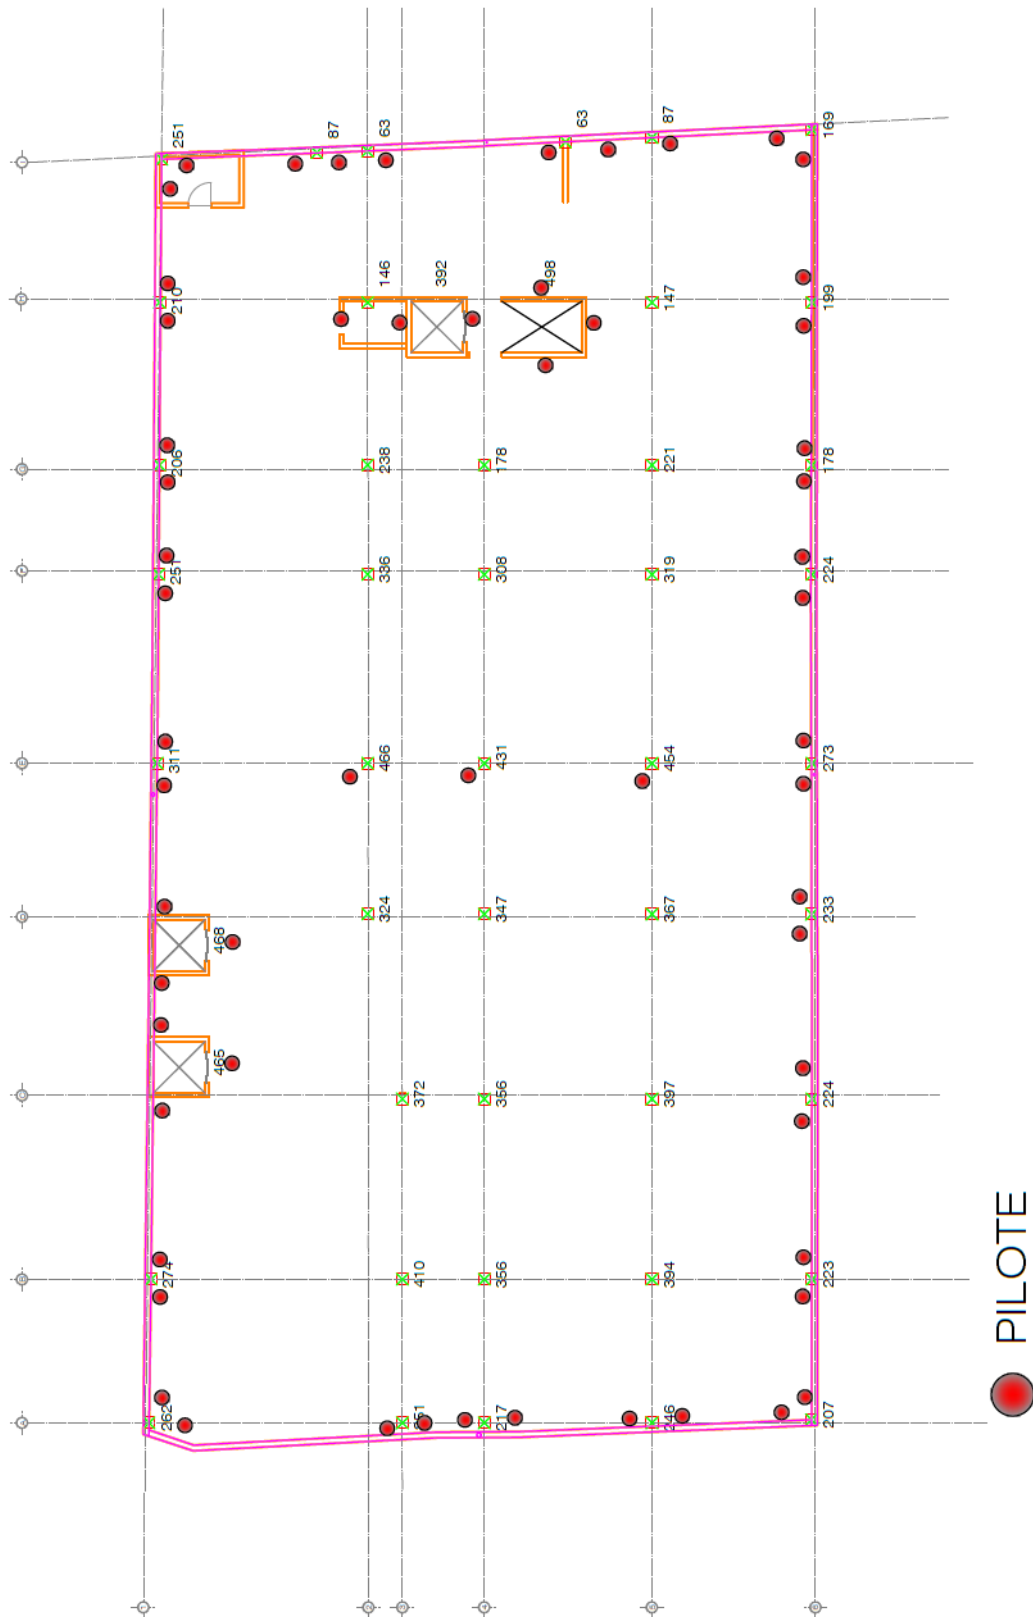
SEMBRADO EN PLANTA DE LOS PILOTE DE CIMENTACIÓN PROPUESTOS TENTATIVAMENTE
